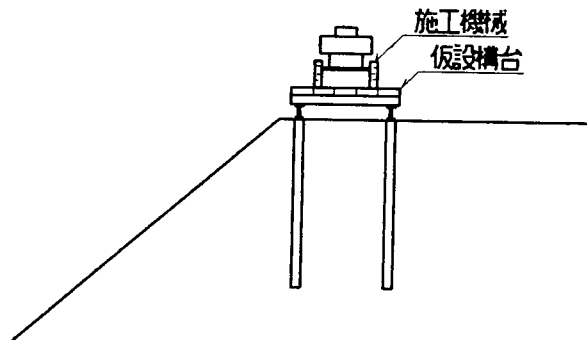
法肩付近での大型施工機械に対する配慮例
